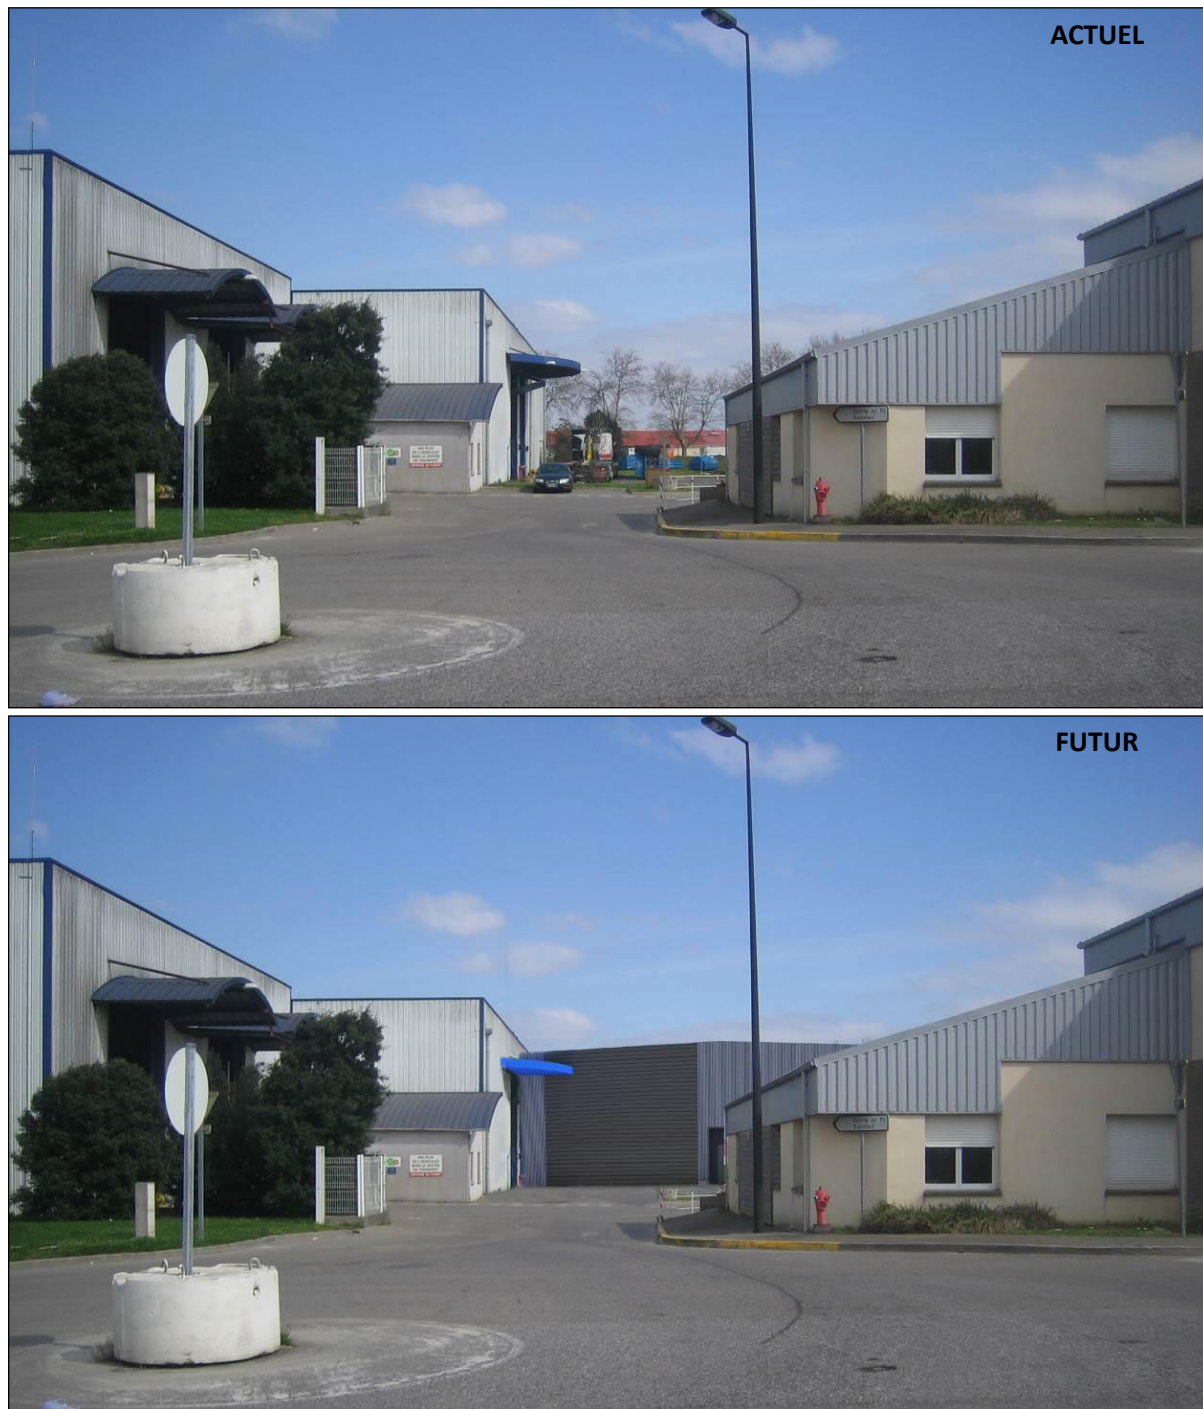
Vue actuelle et vue future depuis le parking du COVALDEM
